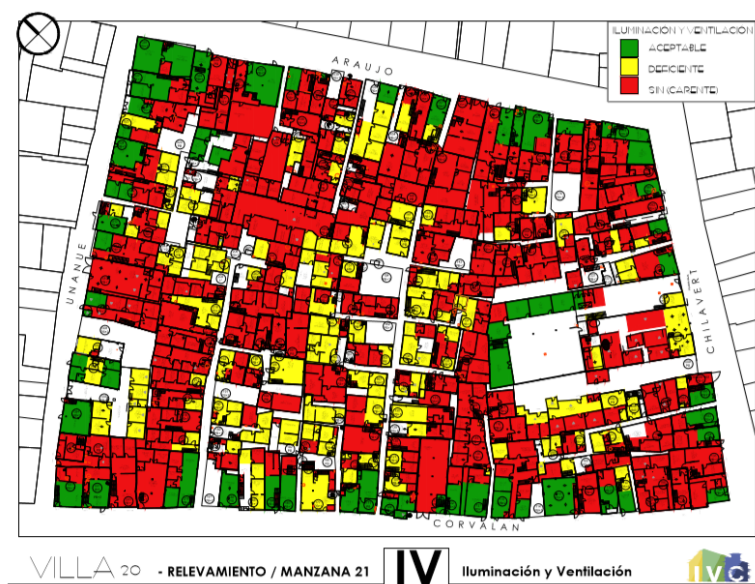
Relevamiento de Manzana 21 y la ponderación de la iluminación y ventilación. Año 2018. Fuente IVC
